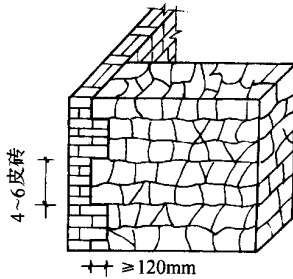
砖墙和毛石墙的转角处砌筑示意图
